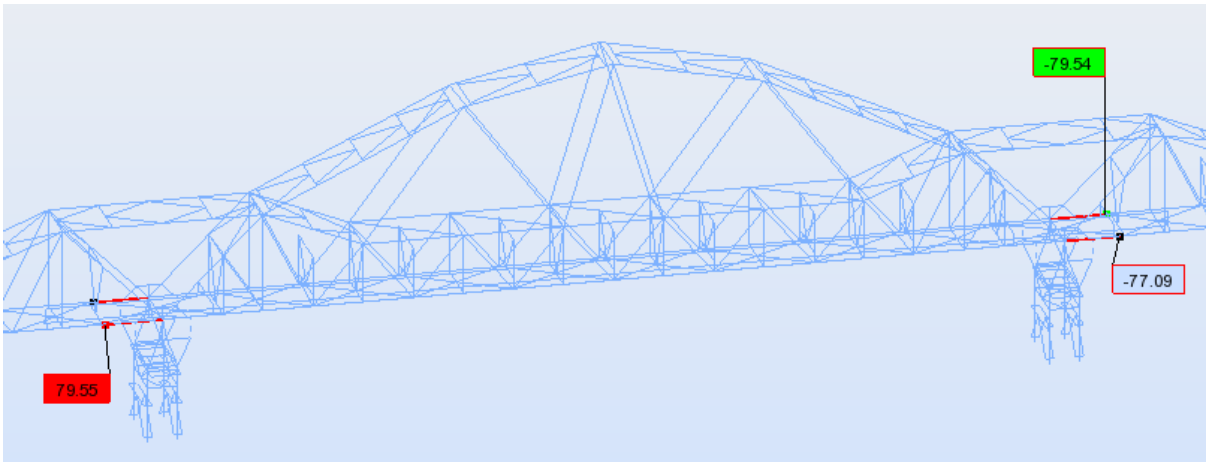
Esforço transverso nos elementos de apoio (após descimbramento)
